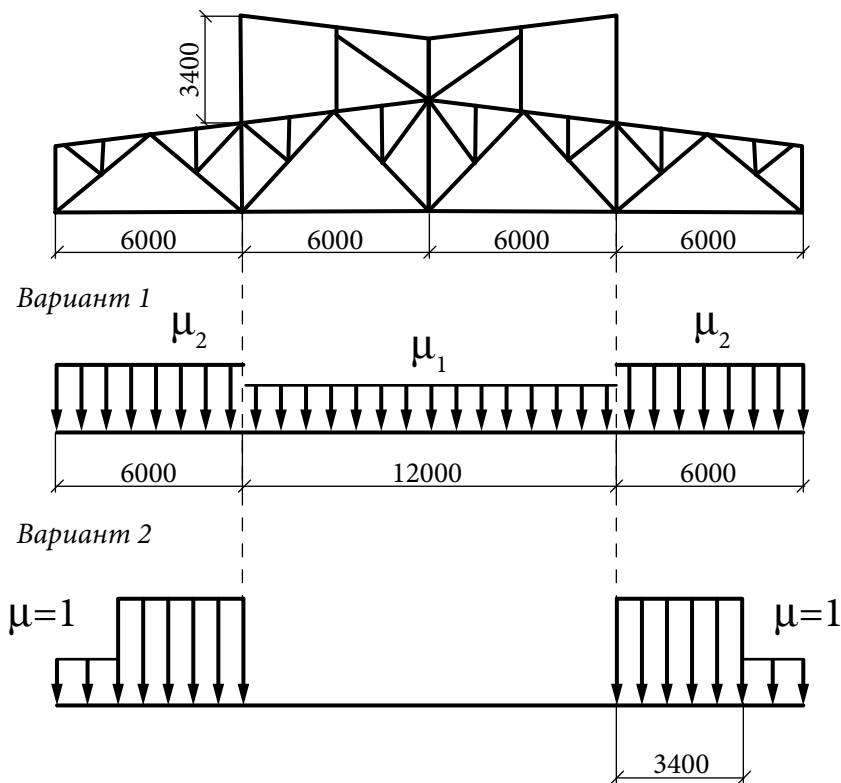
Варианты снеговой нагрузки на ферму
